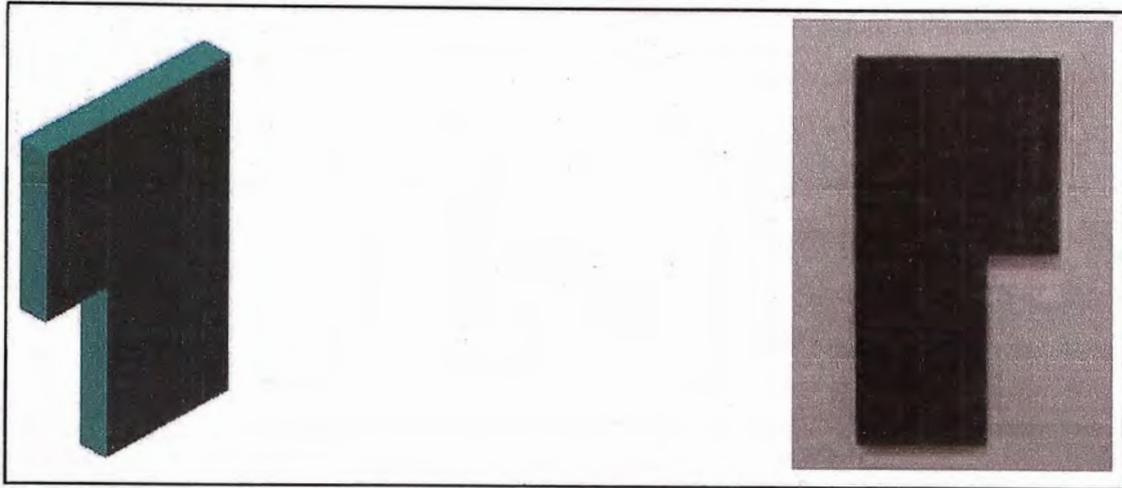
Muro de suelo reforzado – Pin de Anclaje.
